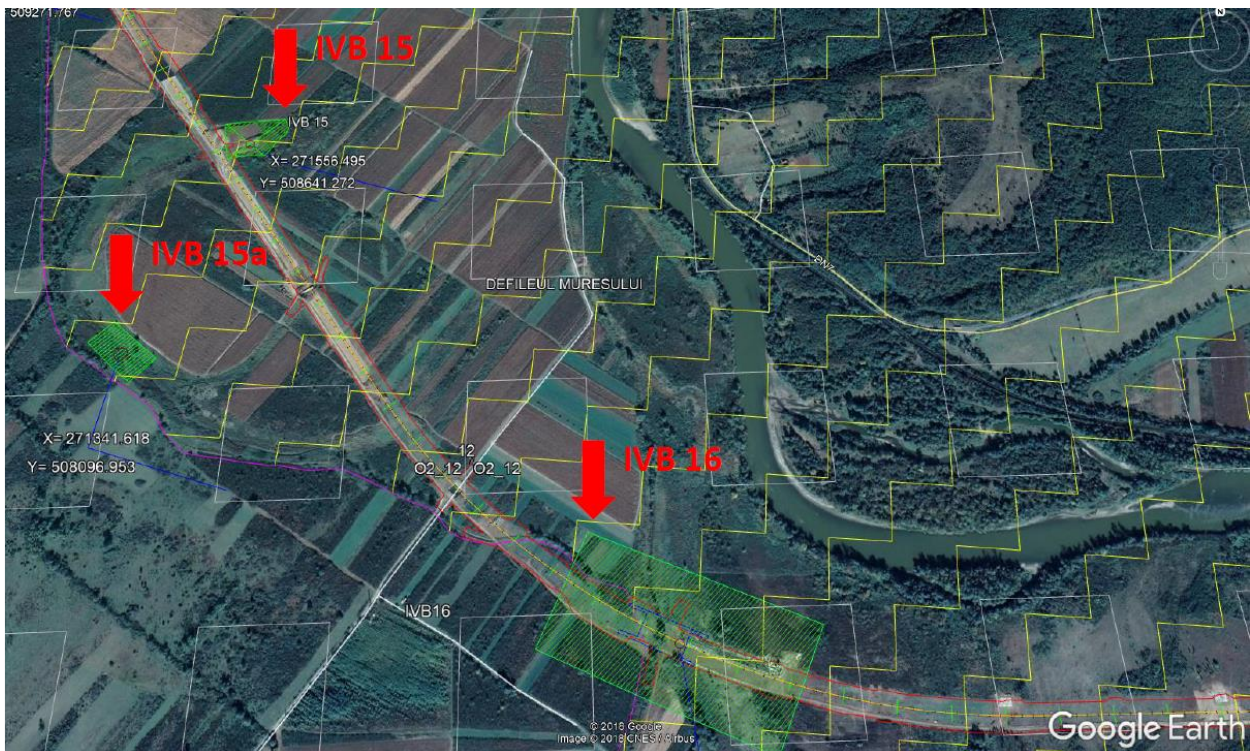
Plan de amplasament pentru platformele IVB 15, IVB 15a, IVB 16 – vedere din satelit
